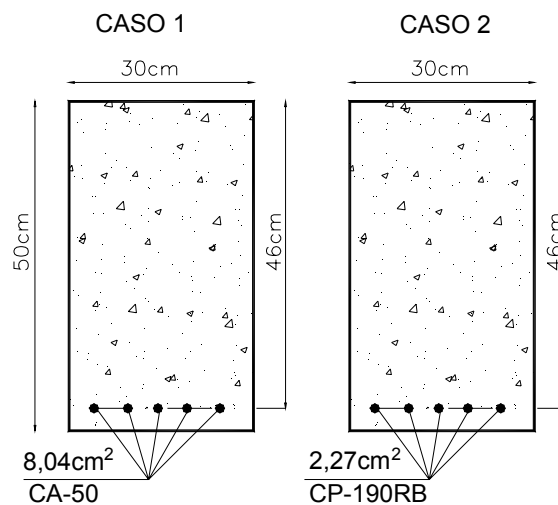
Seções transversais das vigas de concreto armado e de concreto protendido.
